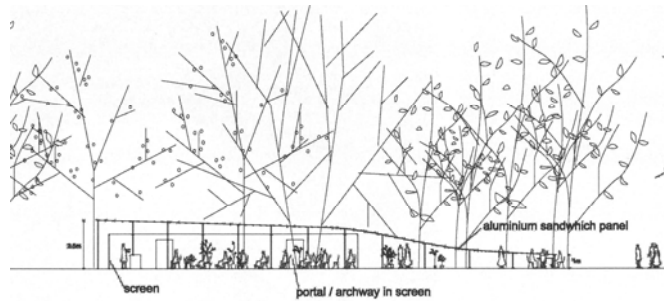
Alçado, pavilhão de SANAA, 2009.
